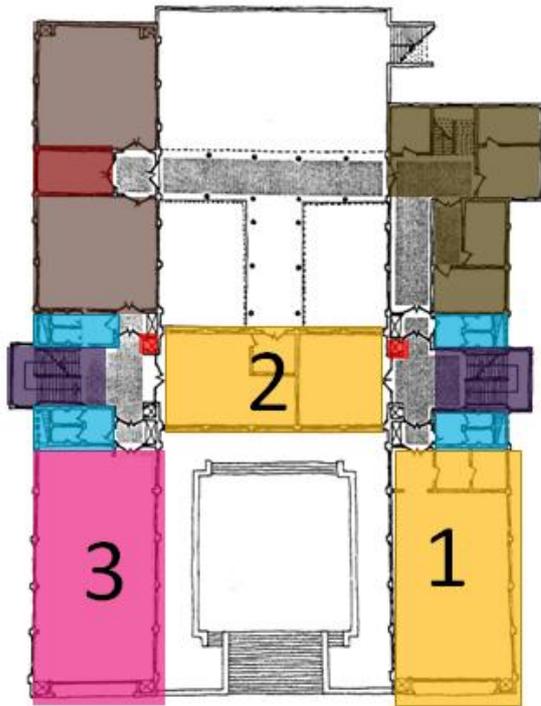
Plan du rez de chaussée de l'école supérieure des beaux arts
